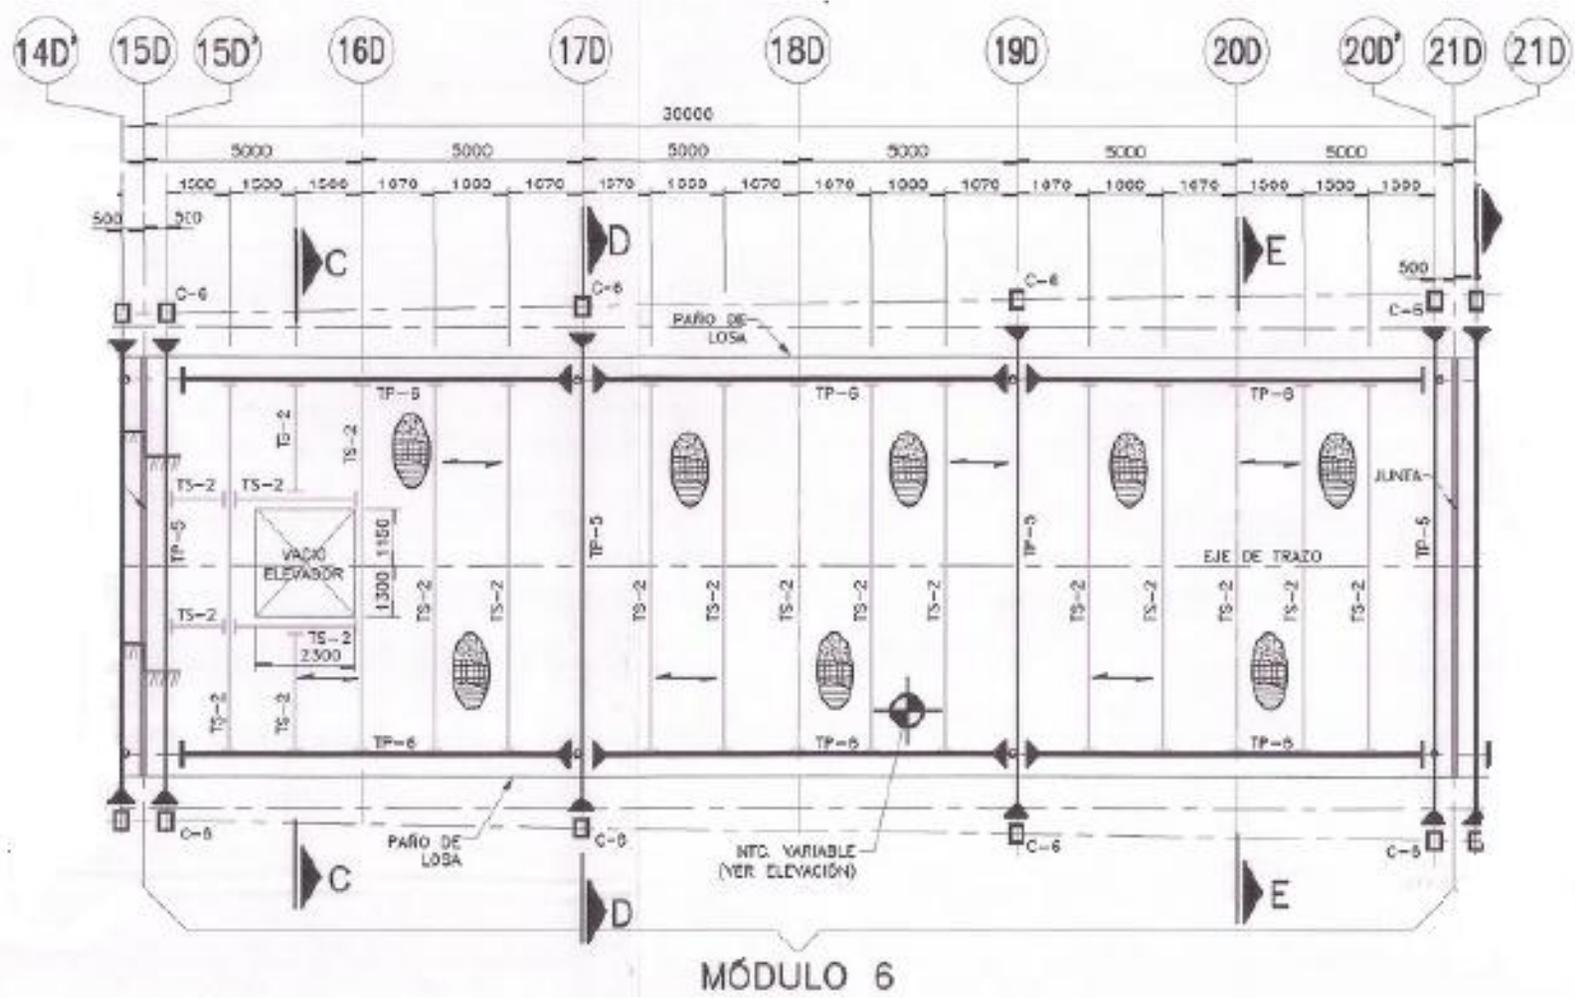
Planta de estructuración nivel azotea, módulo 6.
